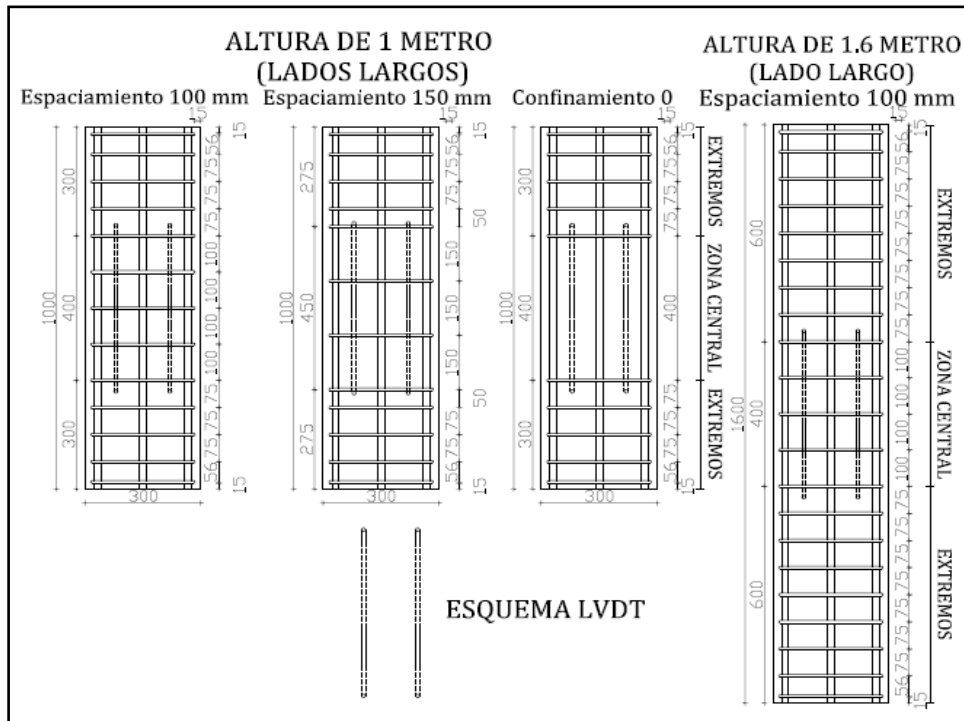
Distribución armadura transversal probetas sin pre tracción (barras cortadas)
